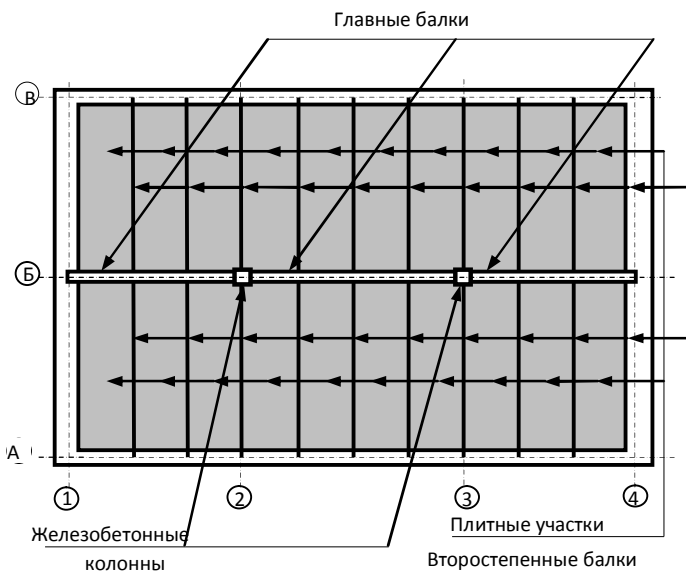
Схема раскладки балок монолитного железобетонного перекрытия
